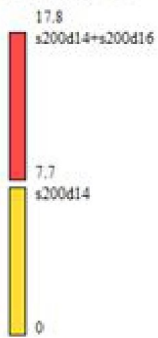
Армования фундаментной плиты (нижне по Y)
